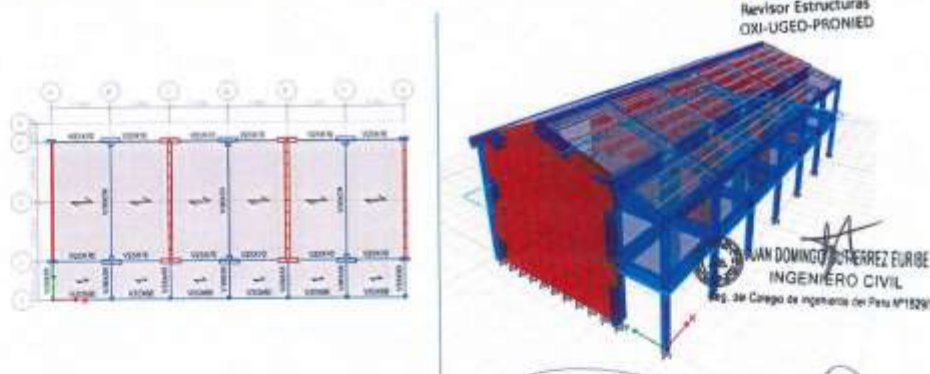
Vista en planta y 3d del Módulo 03 Aulas / 03 Aulas
